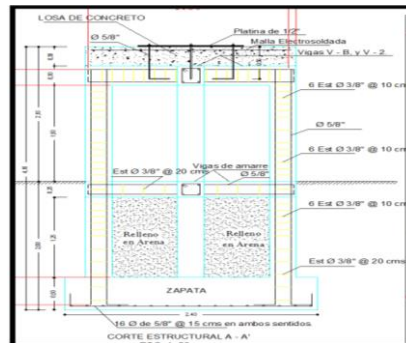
Perfil estructural de cimentación y muro. Fuente ING Jaime Maestre Rodriguez.
